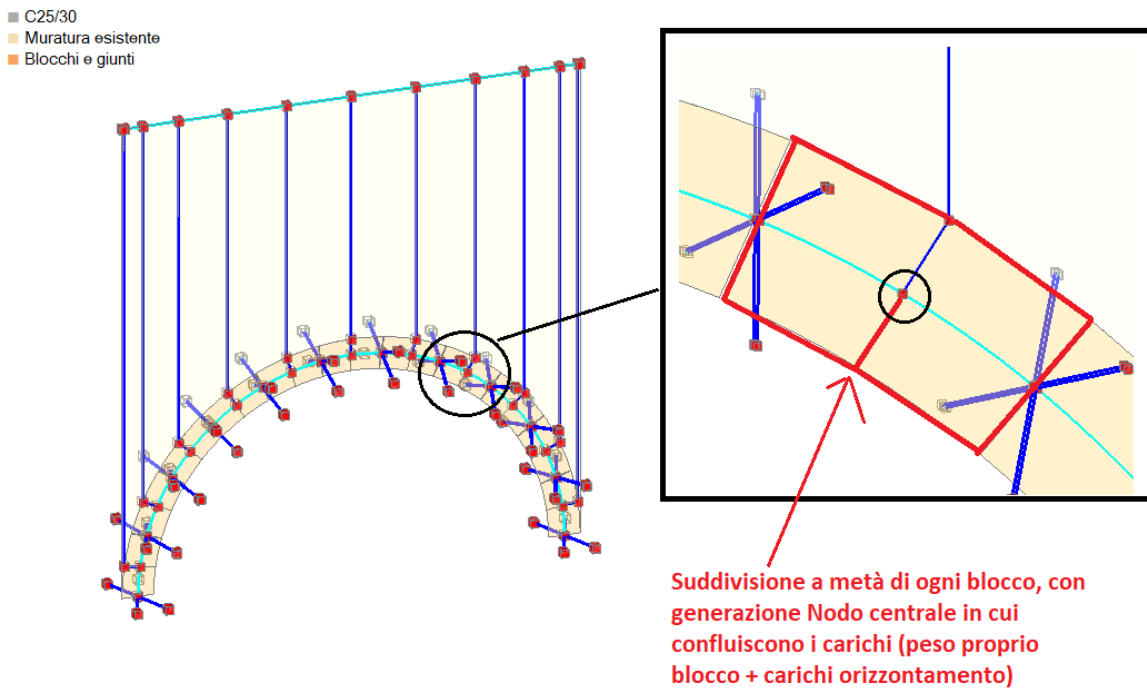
Modello Strutturale – Vista per "Materiale" – Suddivisione dei Blocchi
